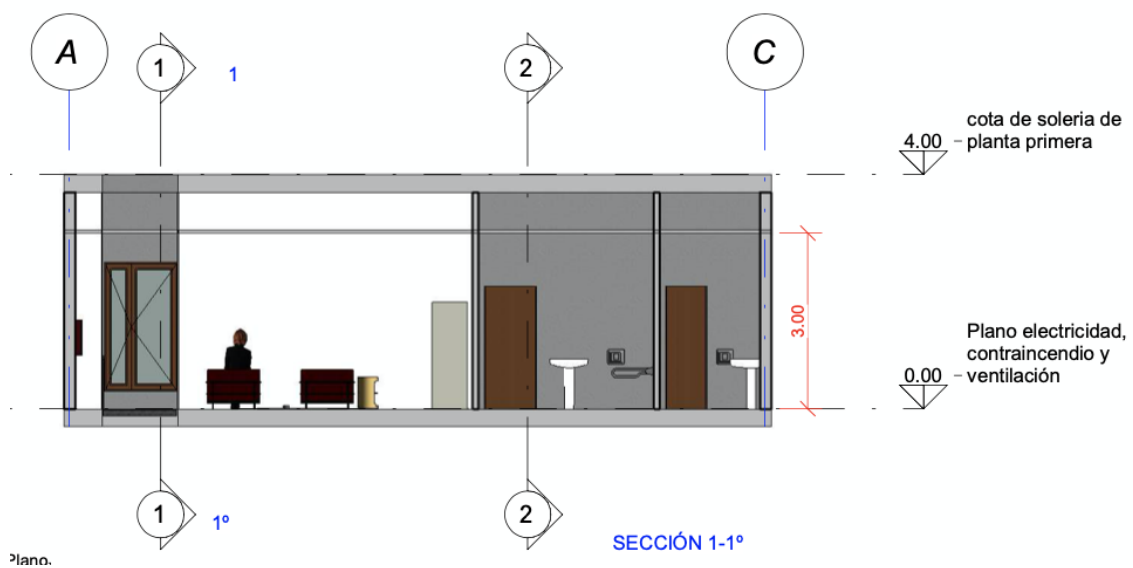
Plano de sección 1. Fuente: Propia y Revit®
